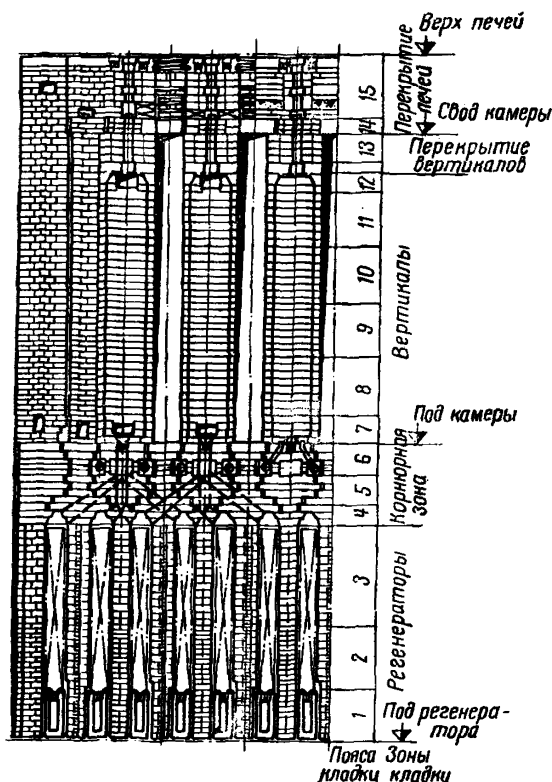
Схема разбивки кладки типовых печей ПВР на зоны и пояса
